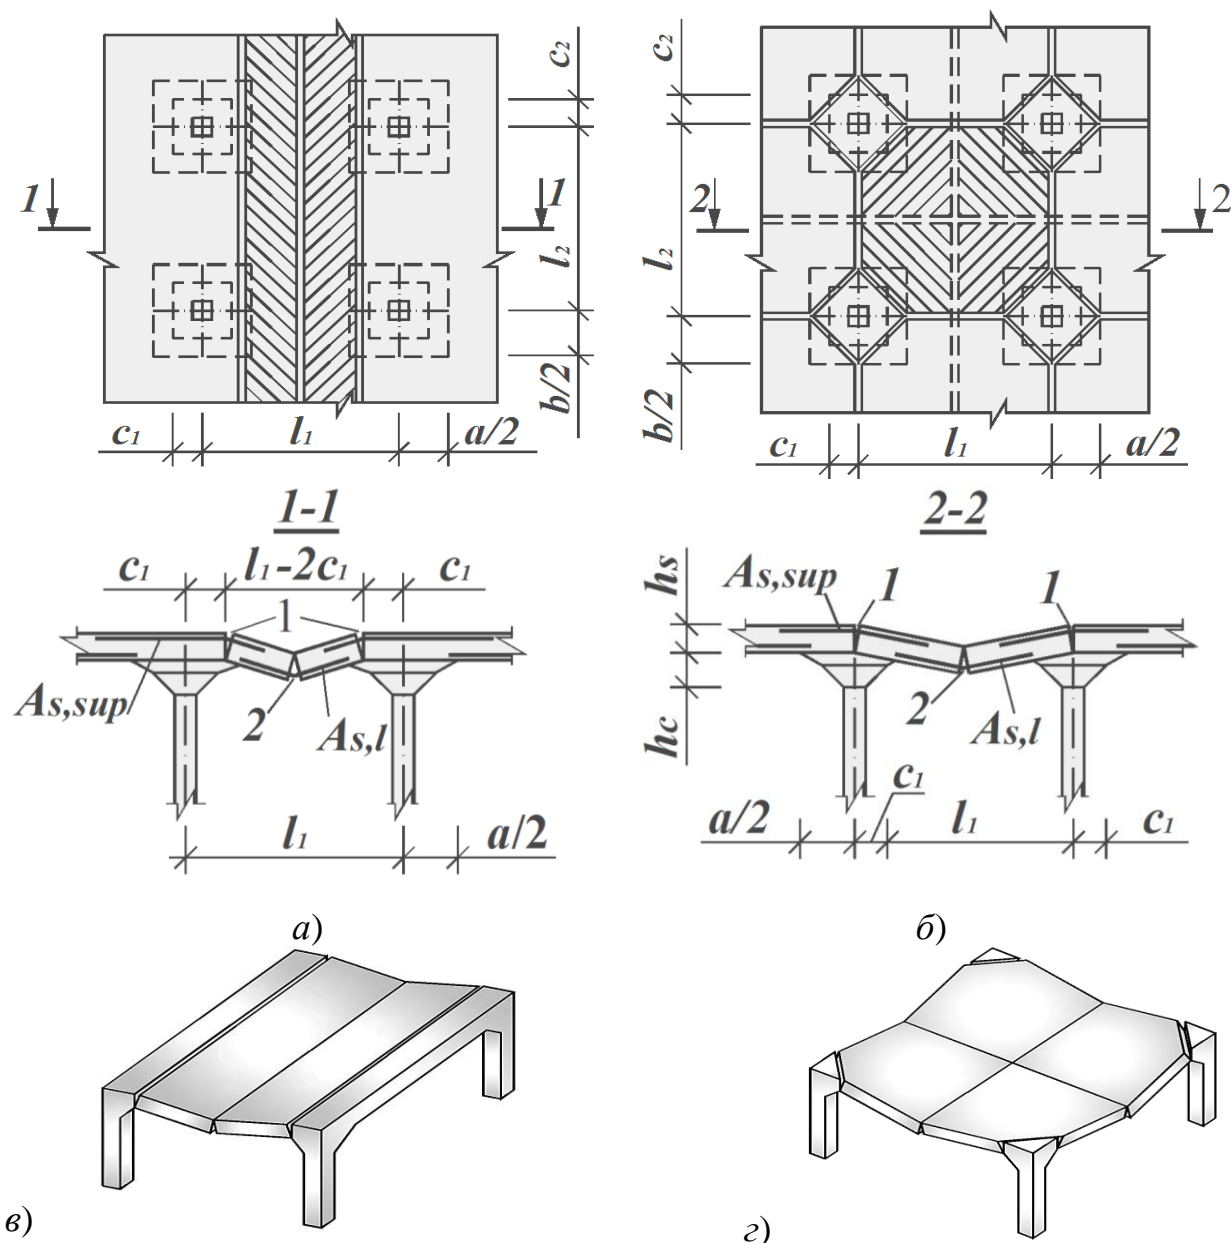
Схеми руйнування безбалкових перекриттів:
